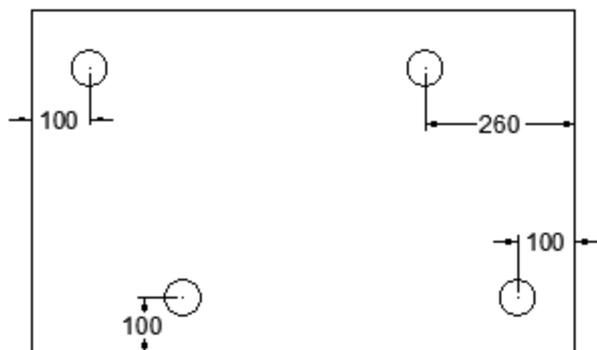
Plans de chevillage - panneaux PAVAWALL-SMART de dimensions 400 × 800 mm
